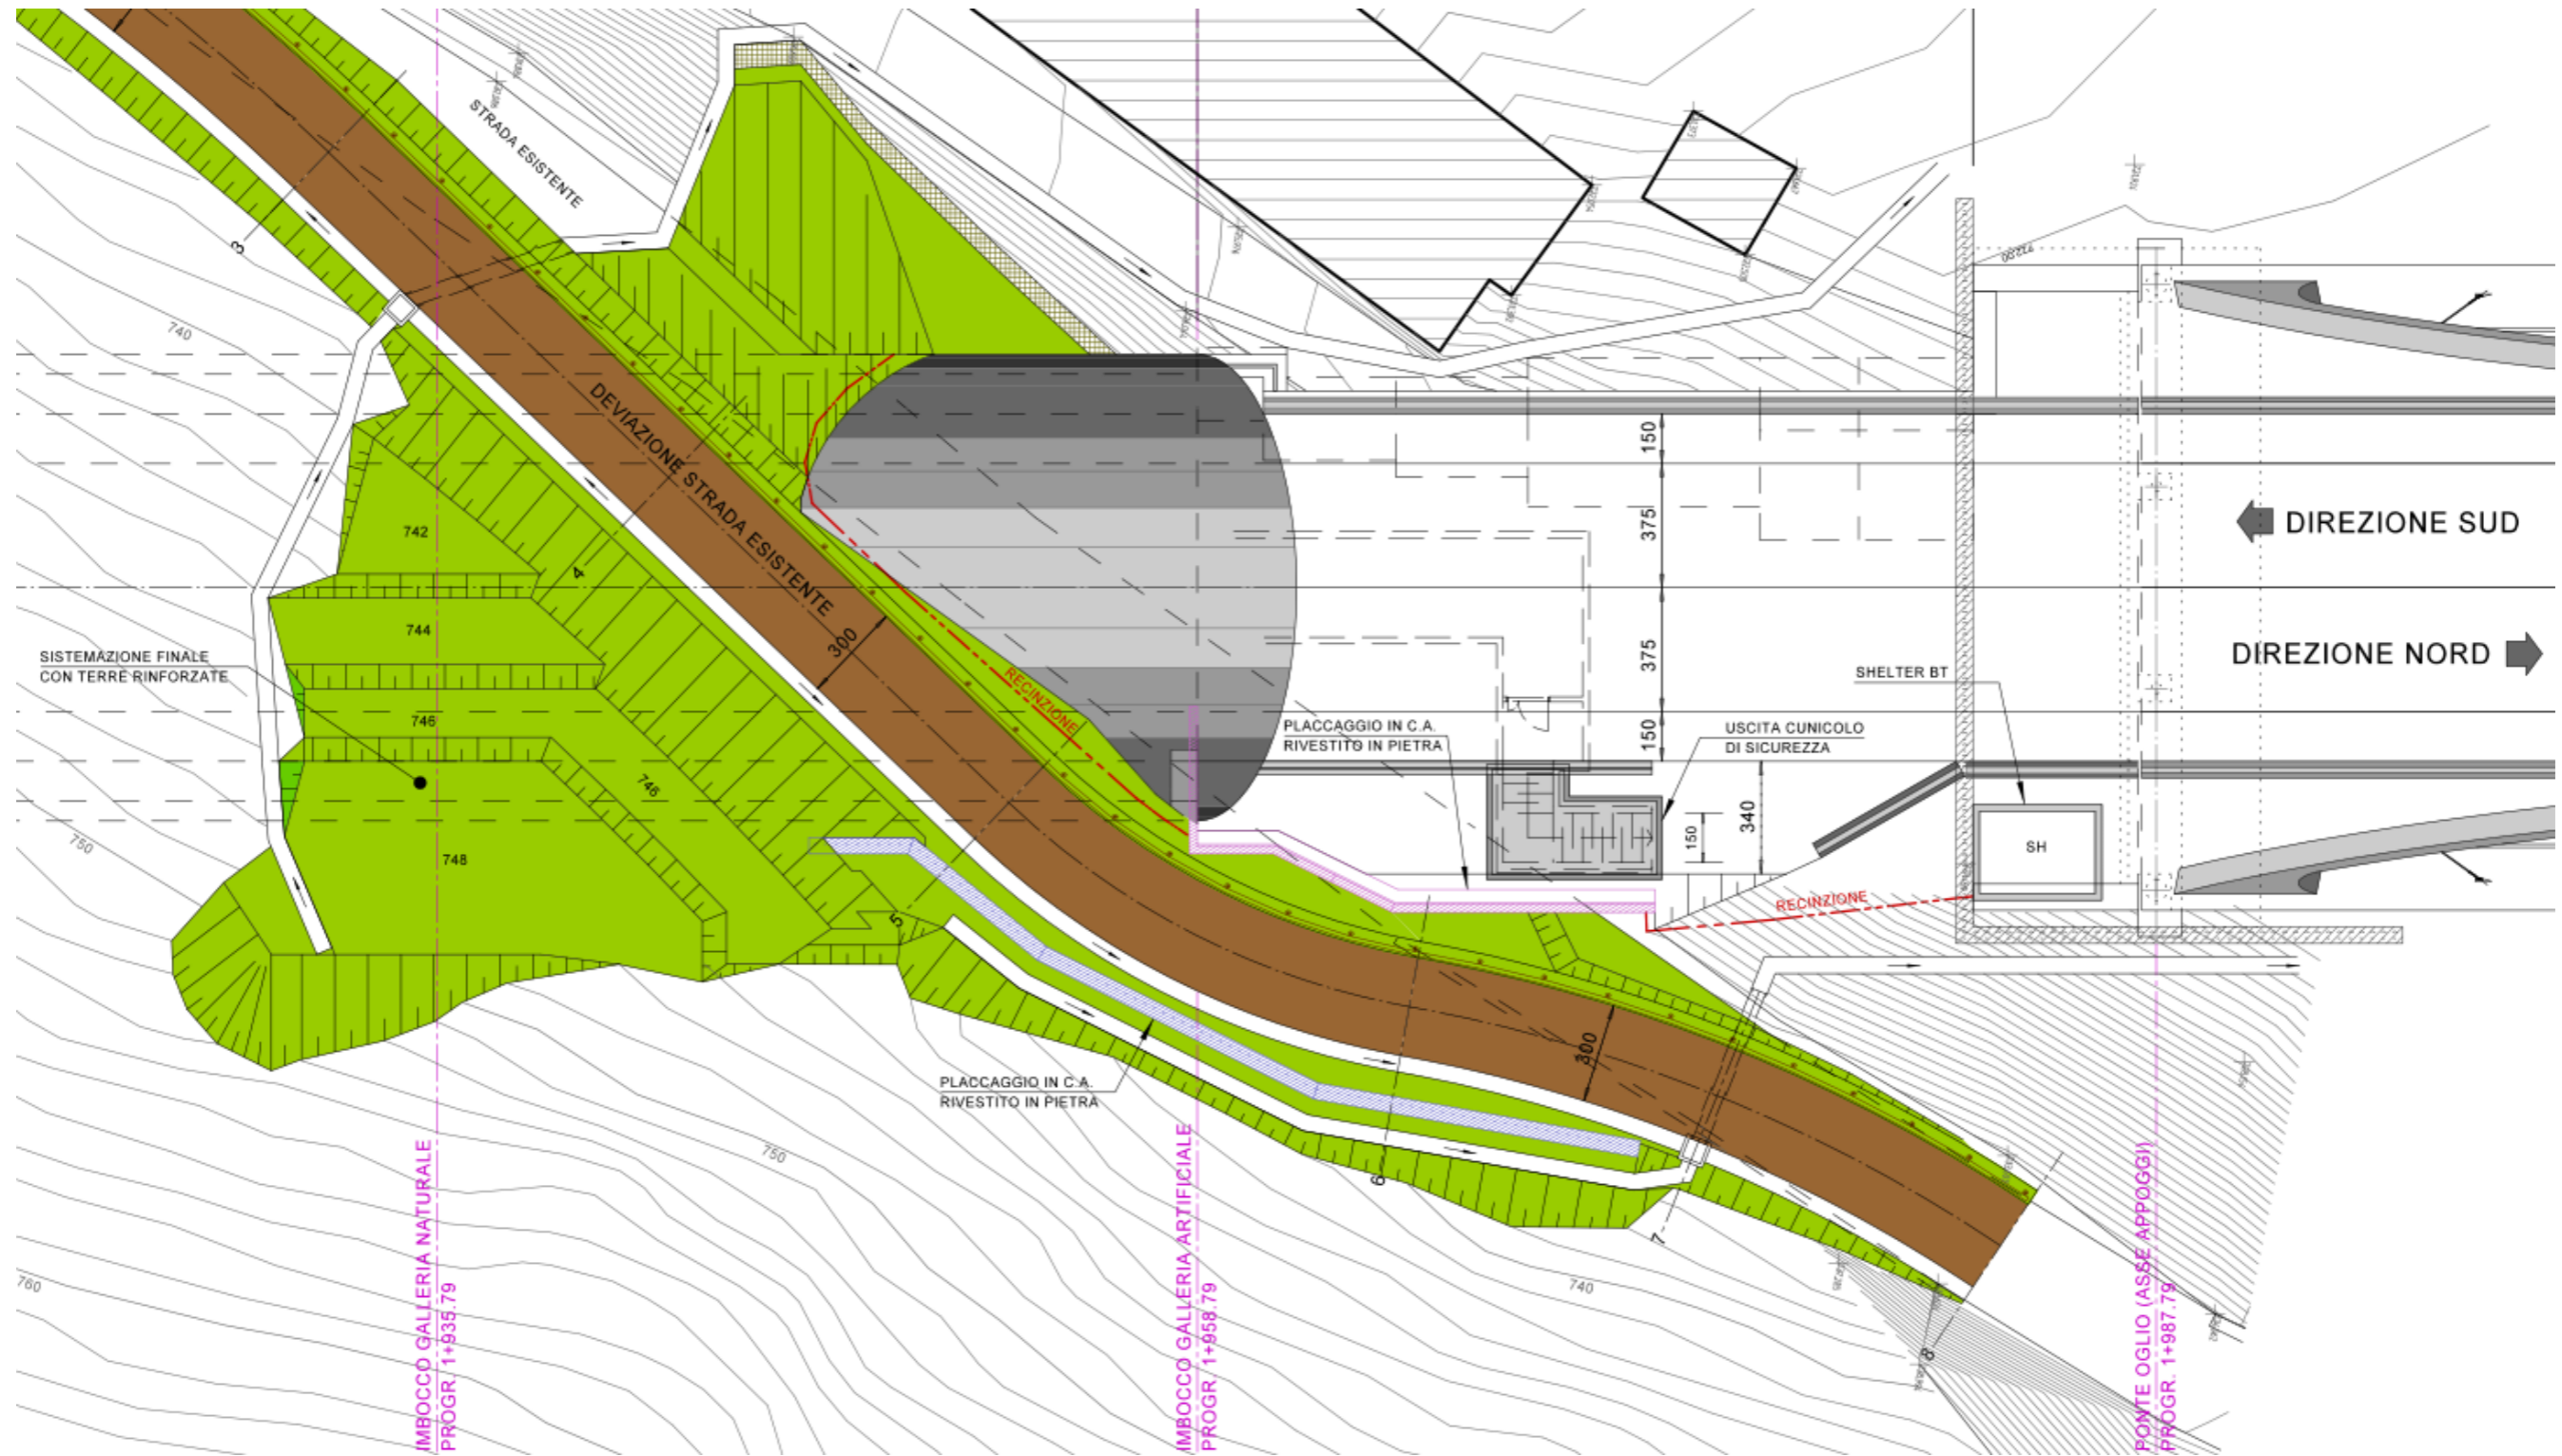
Imbocco Nord – Planimetria sistemazione finale
